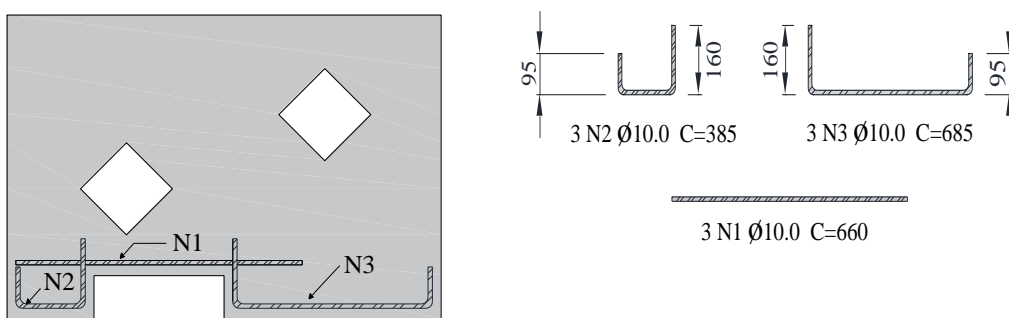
Detalhamento das armaduras DB1-H2-U, DB3-H2-U e DB3-H2-S-FS (dimensões mm)
